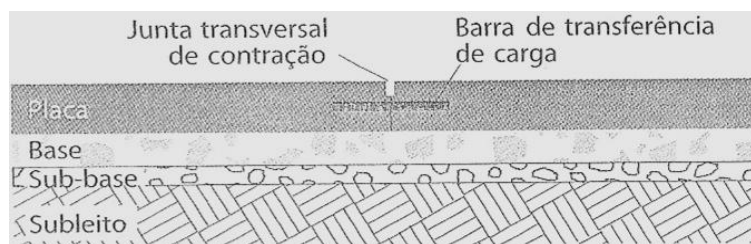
Seção tipo: Pavimento de concreto simples (Balbo, 2009)
